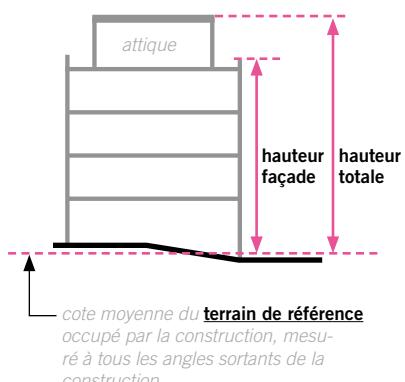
Hauteur de façade et hauteur totale d'un bâtiment
